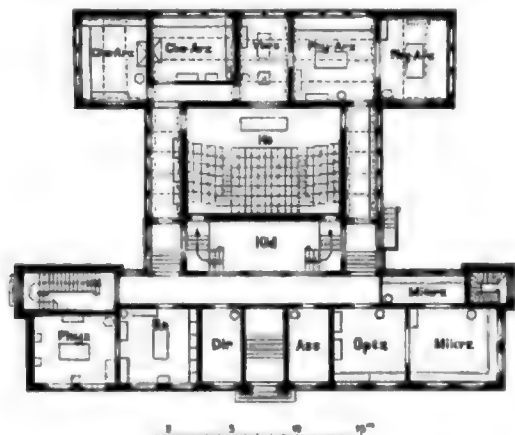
Grundriss vom Erdgeschoss.
